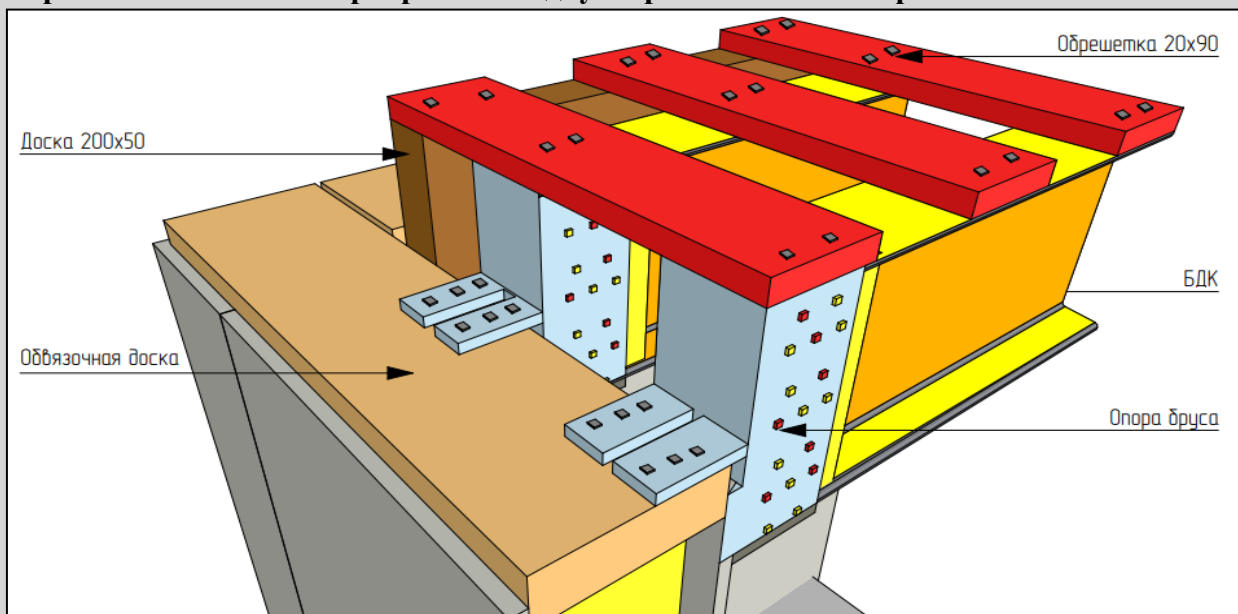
Монтаж опор бруса и балок перекрытия на внешних и внутренних стенах
